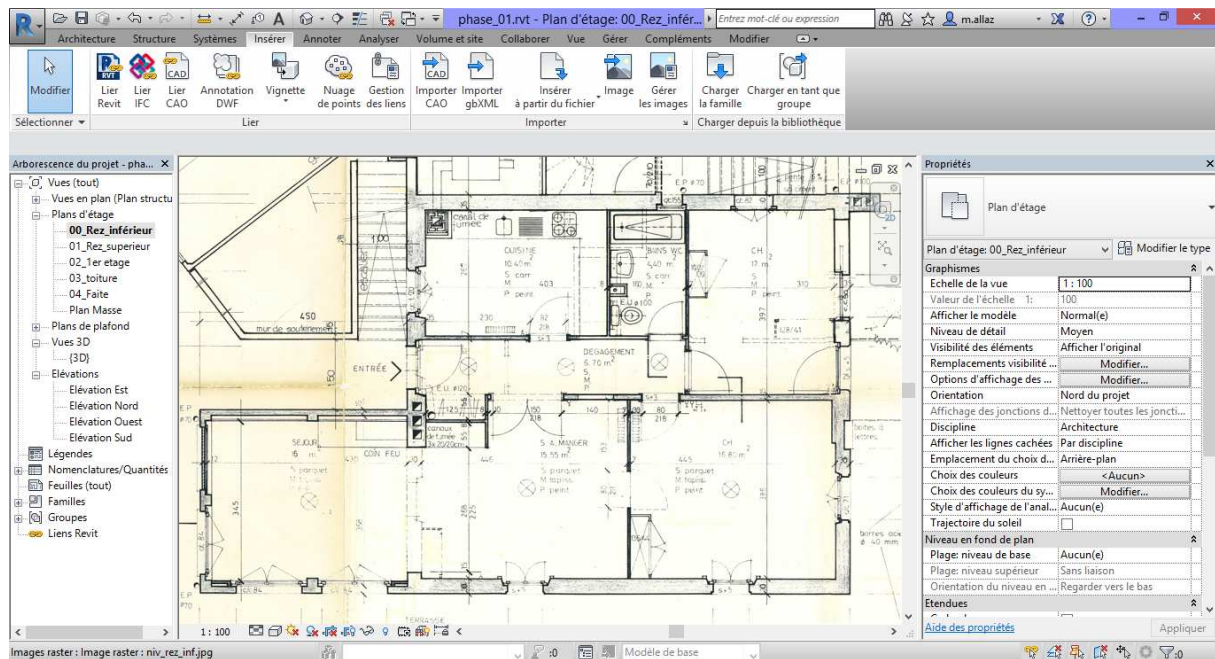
Insertion d'un plan d'étage comme fond de plan © Revit
